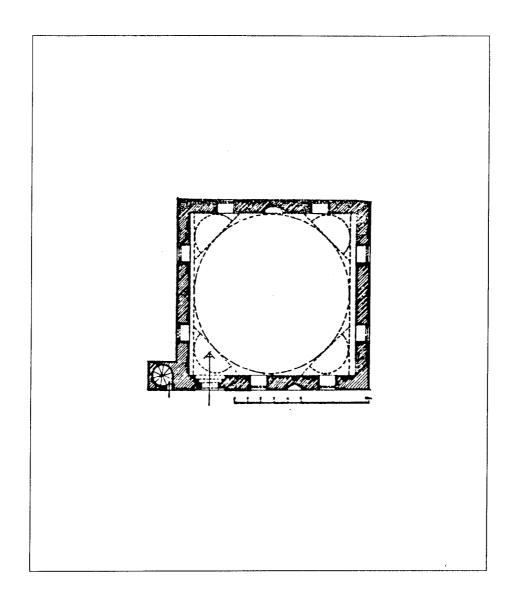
مسقط أفقي لمسجد شاه ملك في أدرنة (عن : أصلان أبا) .
